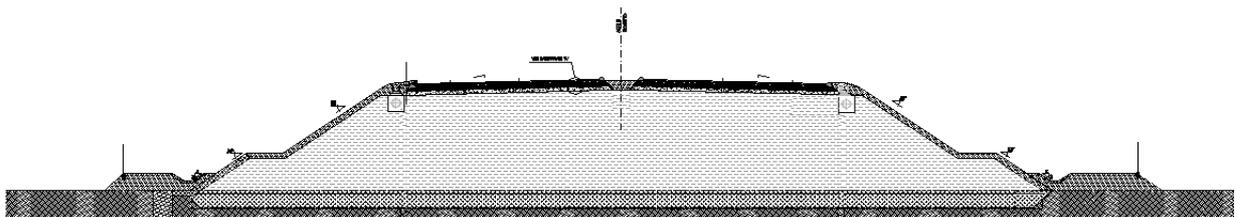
Sezione in rilevato in rettilineo
